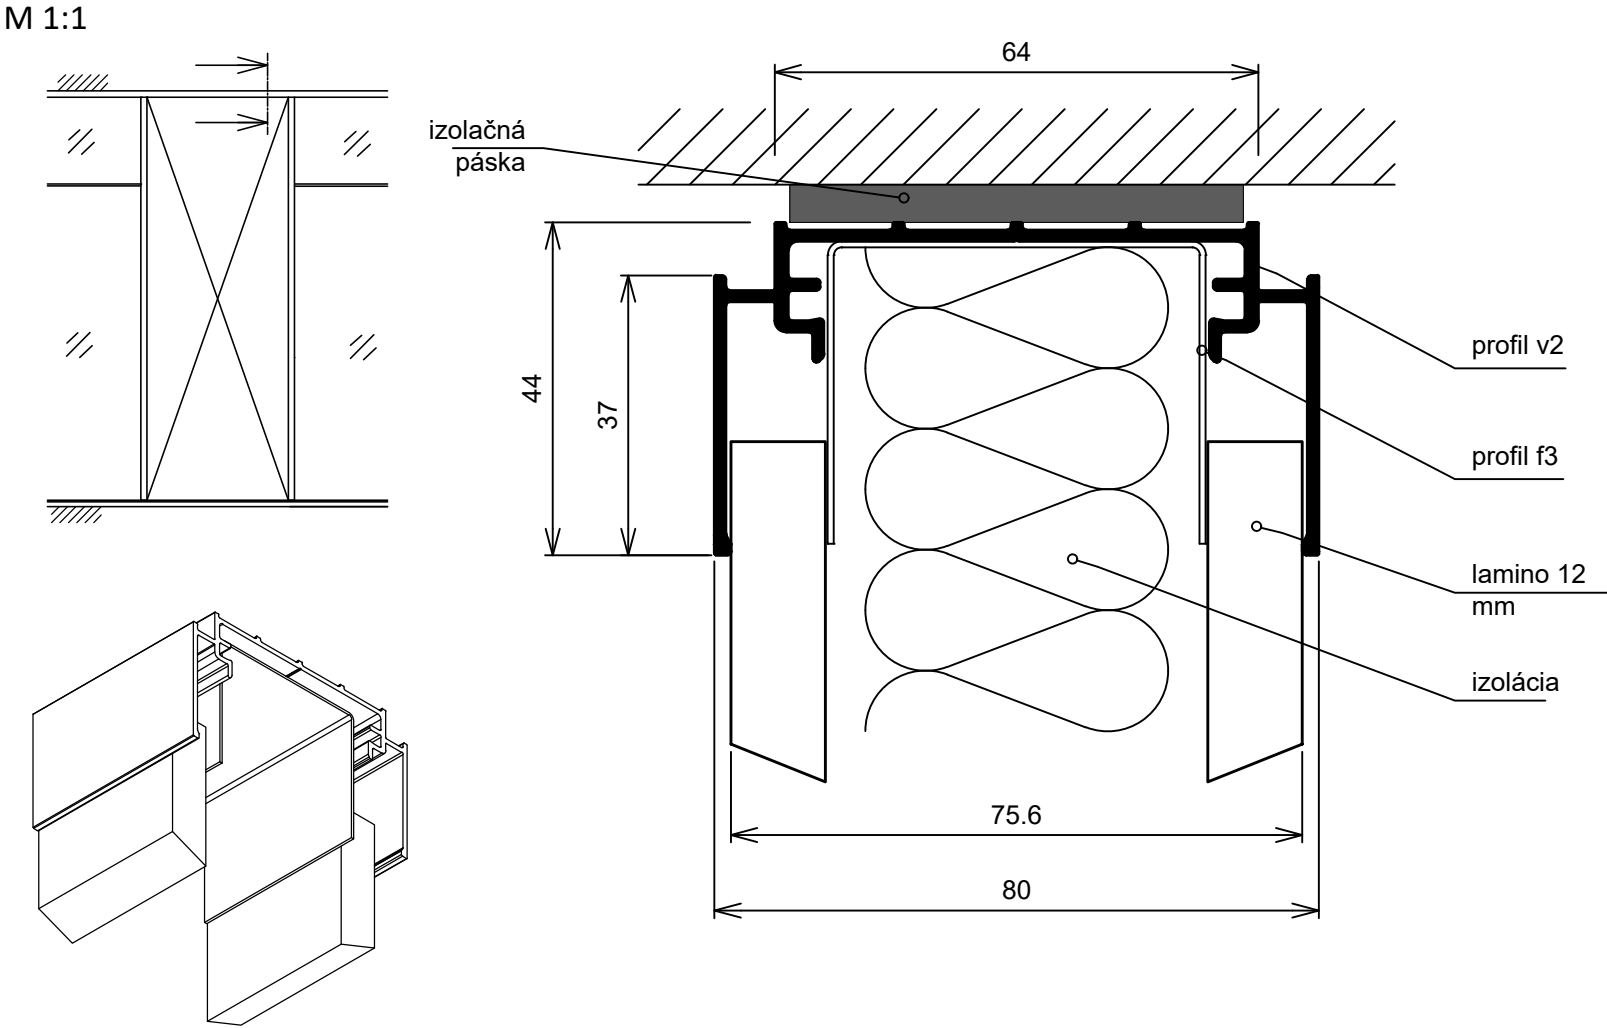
DETAIL NAPOJENIA PRESKLENEJ PRIEČKY PRI PODLAHE
